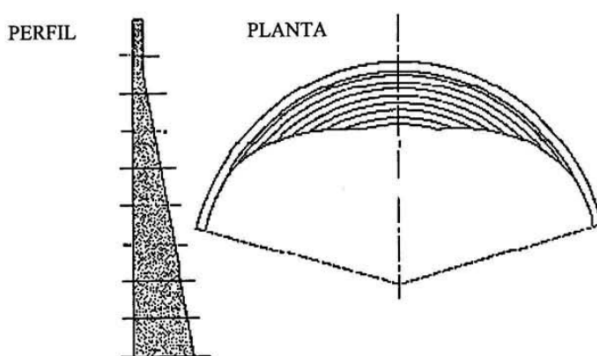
Corte e Planta de uma Barragem definida através de arcos circulares de raio constante (Batista, 1998)
